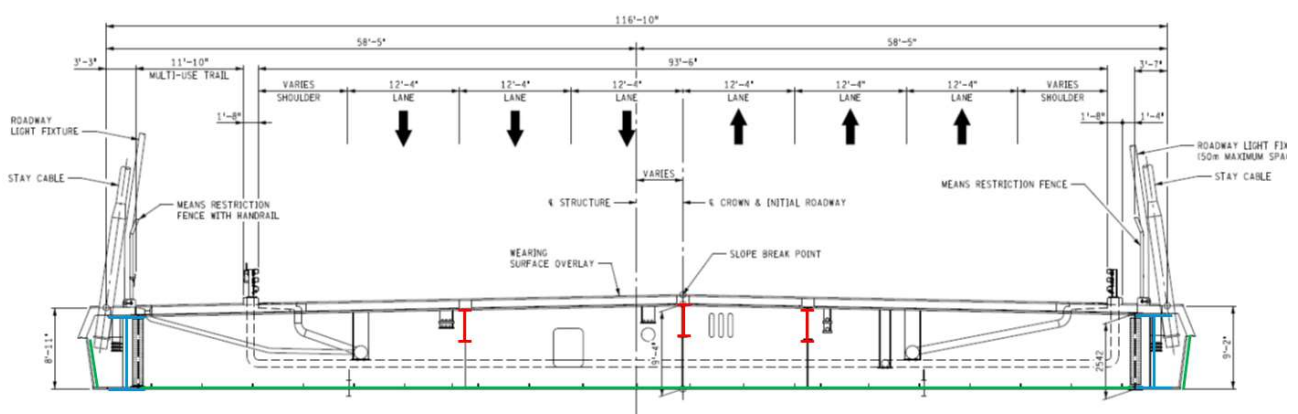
Sección transversal del tablero, incluidas las vigas de borde (azul), el panel de recubrimiento inferior de acero no estructural (verde) y tres vigas de redundancia (rojo)
